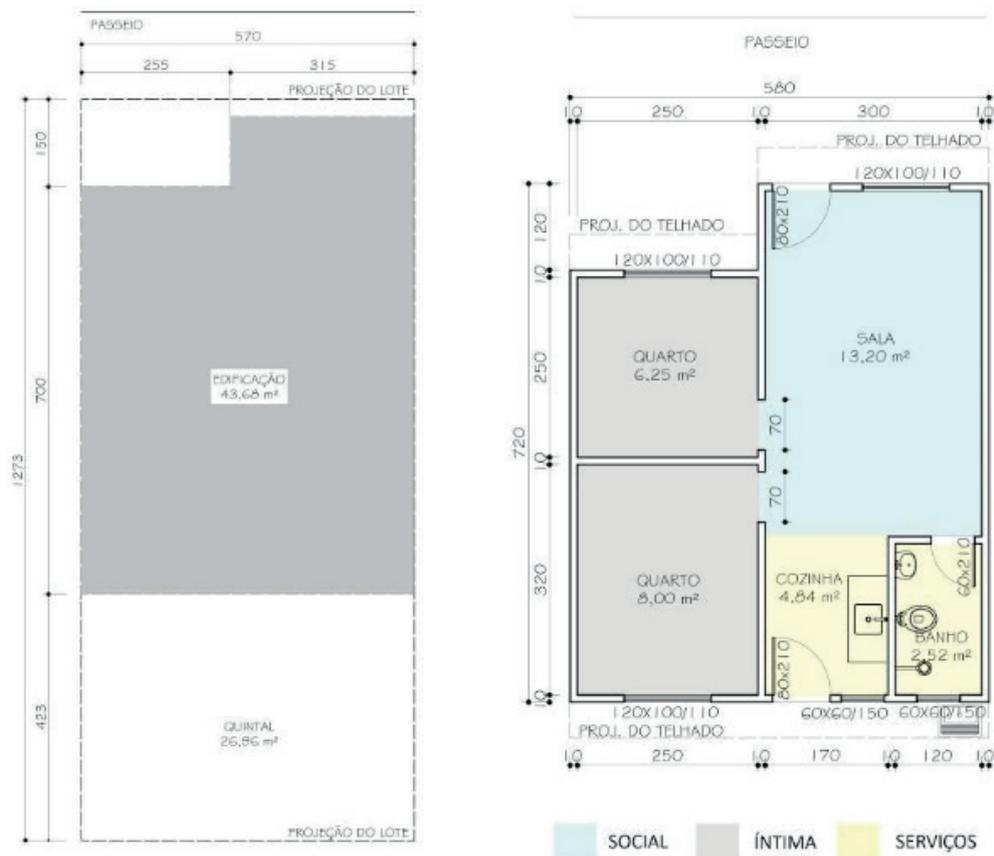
Implantação da unidade habitacional no lote (esquerda) e planta baixa (direita).
